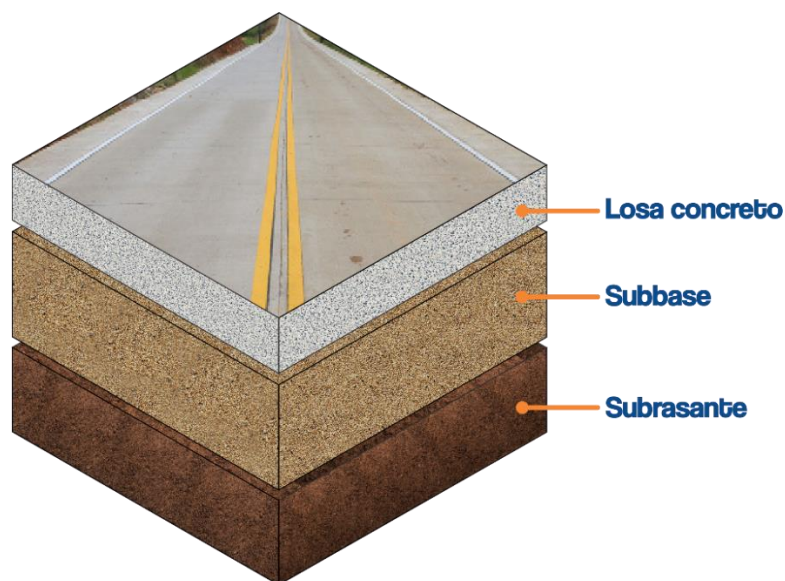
Vista isométrica de la configuración estructural de un pavimento rígido. Elaboración propia.
